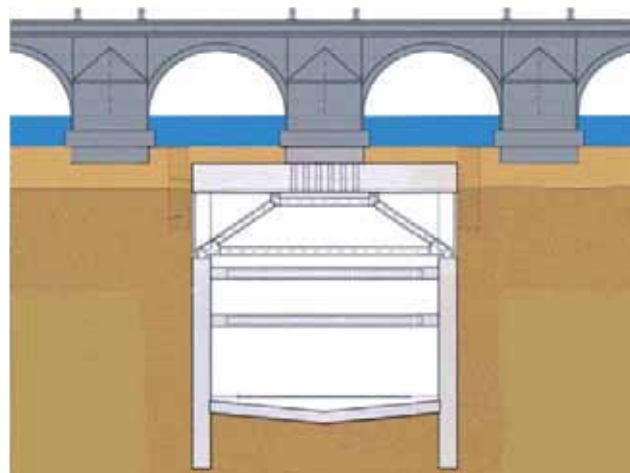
Sección bajo pila del puente de Segovia. CALLE 30. Madrid.
